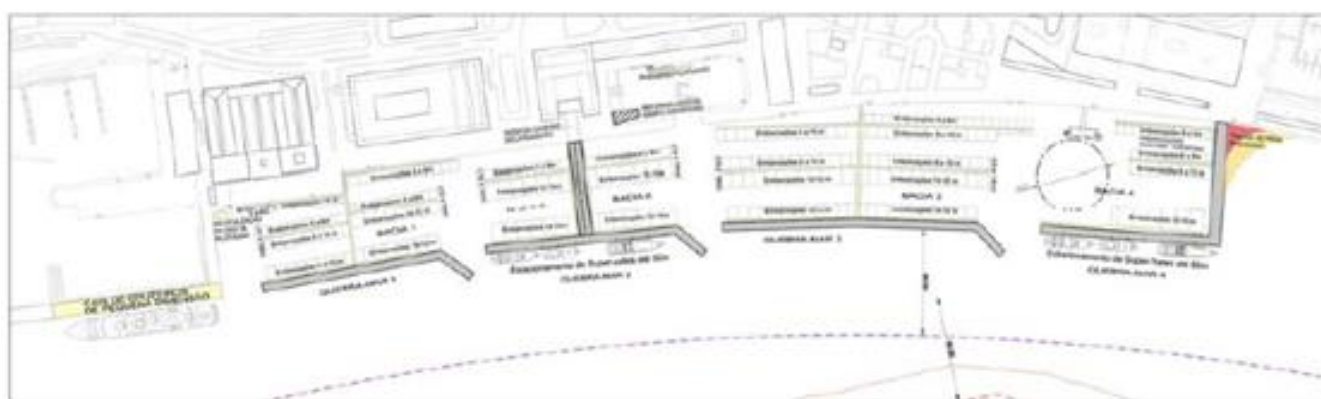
Extrato do Arranjo Geral da Solução 1 (layout A1')
